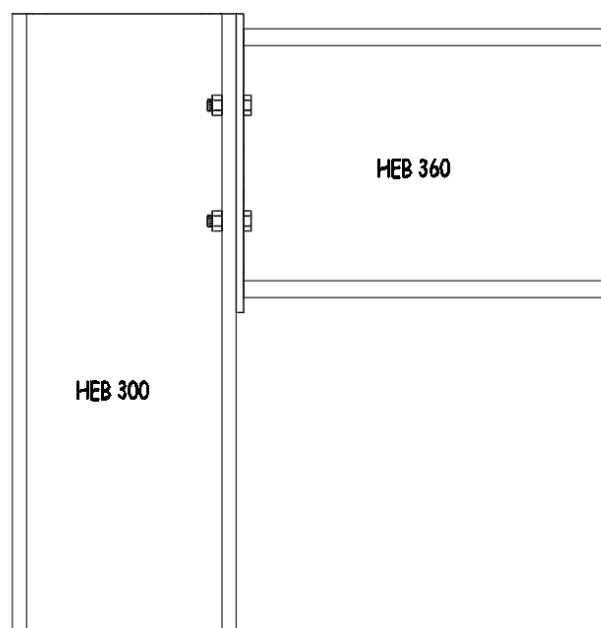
Ligação do pilar com a viga V1 do piso 2
